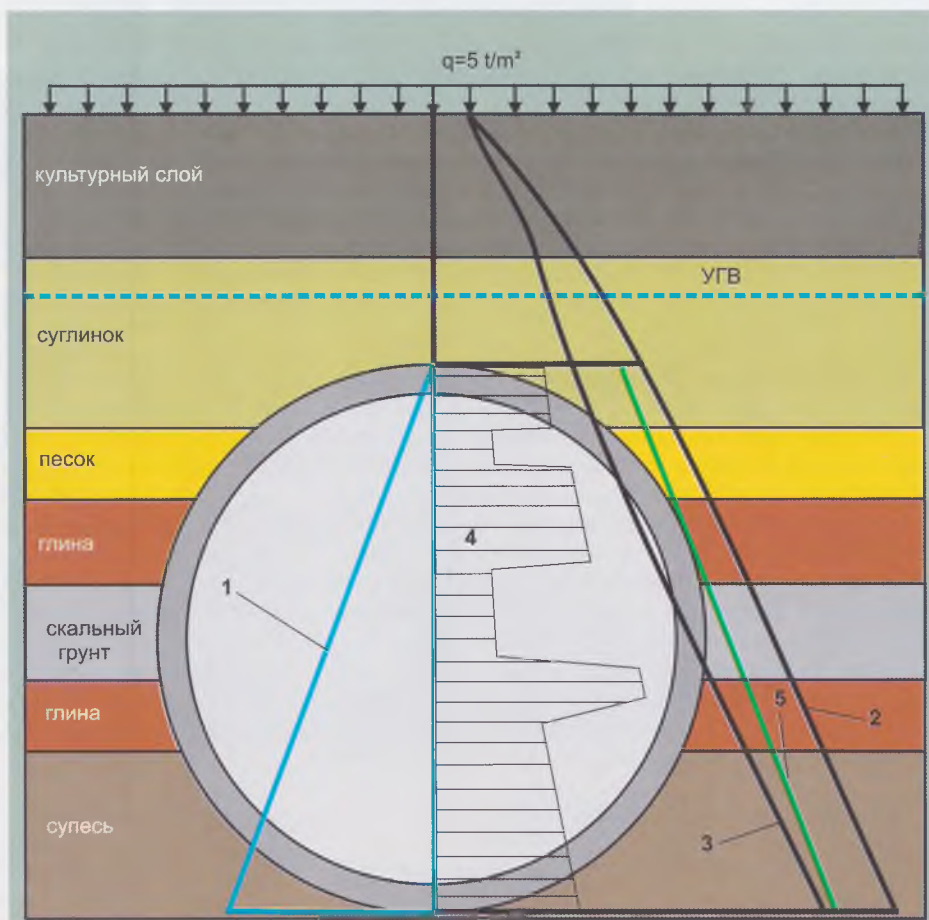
Пример определения давления пригруза забоя: 1 – давление грунтовых вод; 2 – вертикальное давление от веса полного столба грунтов; 3 – вертикальное давление грунтов по модели «опускающегося столба»; 4 – эпюра горизонтального (бокового) давления грунтов в забое; 5 – расчетное давление пригруза в забое с учетом давления грунтовых вод и объемного веса бентонитовой суспензии
